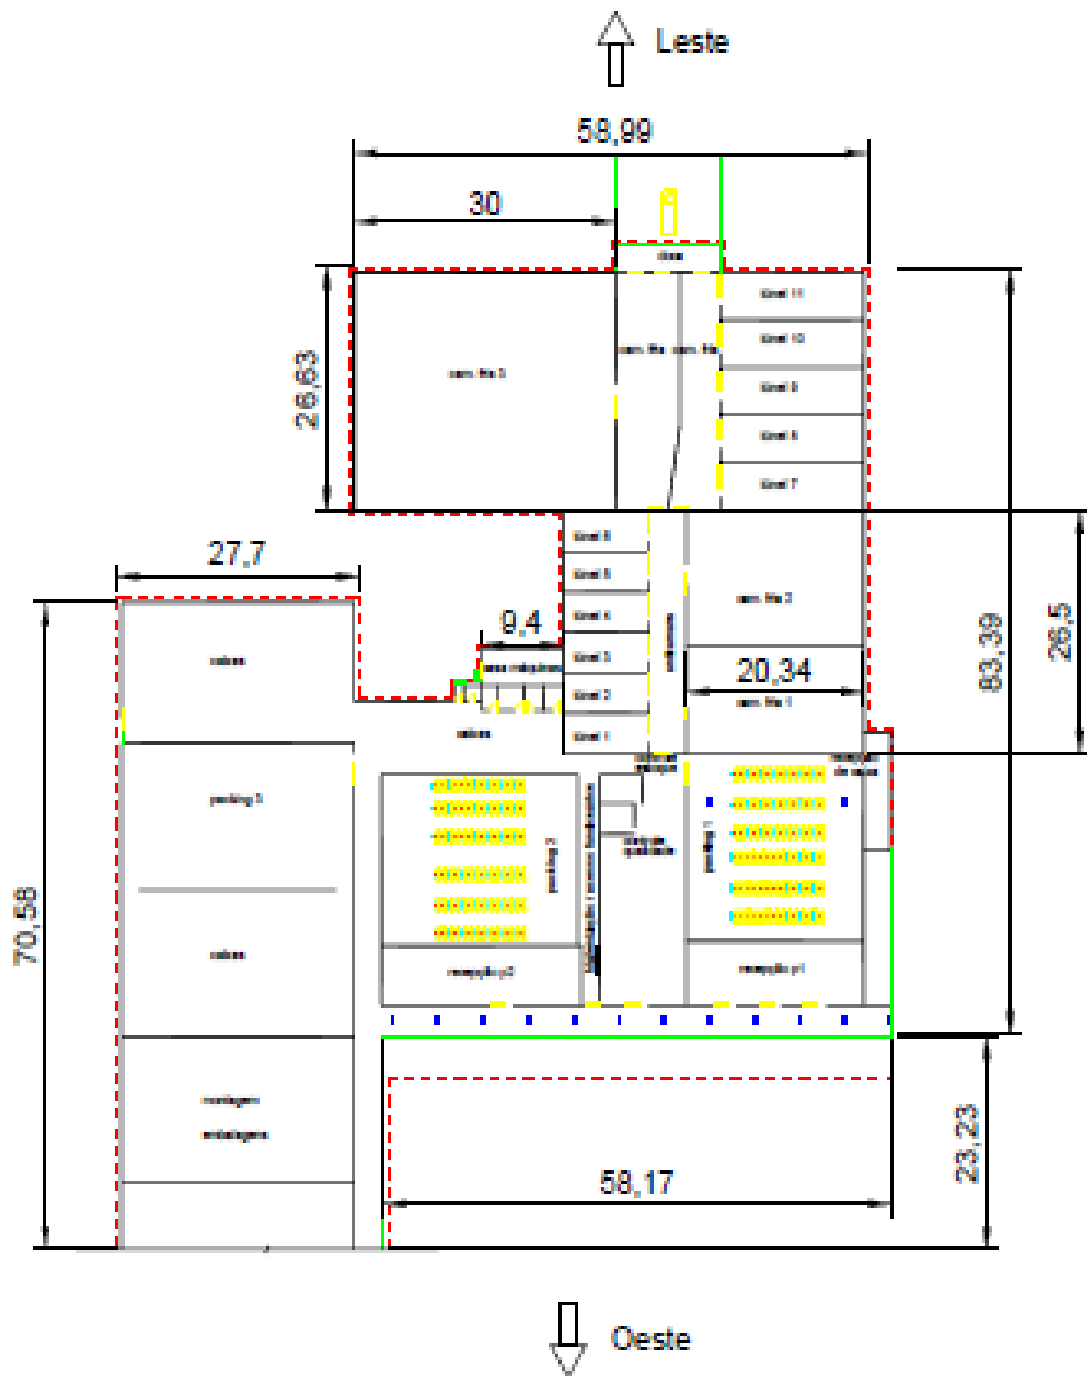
Planta Baixa do *packing house* da *Special Fruit
